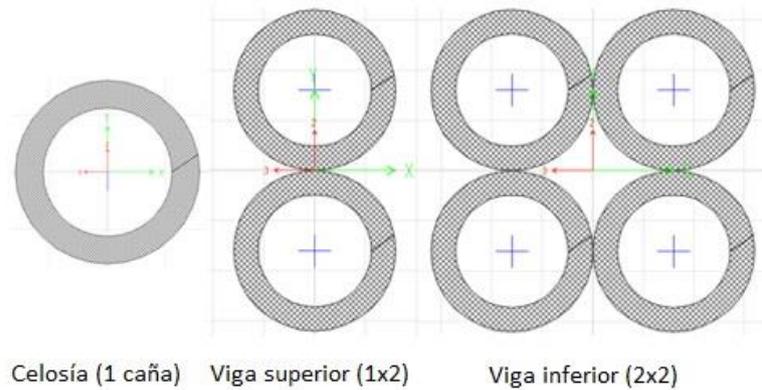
Sección transversal para los miembros de la cercha. Fuente: Propia
